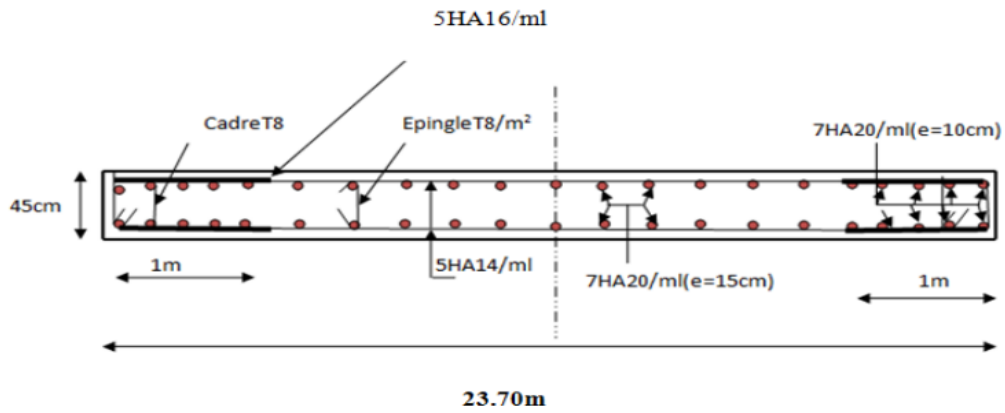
Ferrailage des voiles extérieurs aux appuis coupe (Y-Y').
